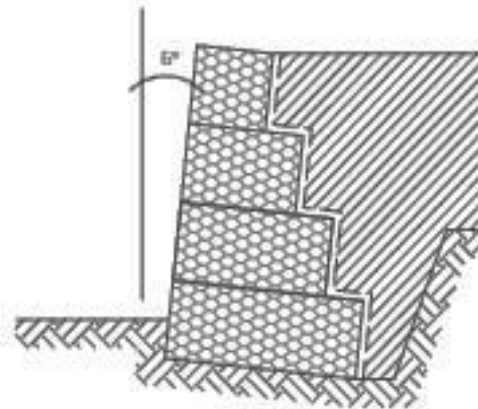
Muro inclinado  $6^\circ$  hacia atrás
